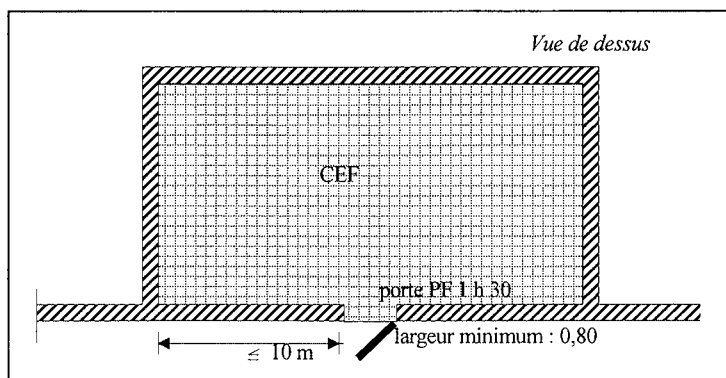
Porte situé sur la paroi extérieure d'un CEF.
